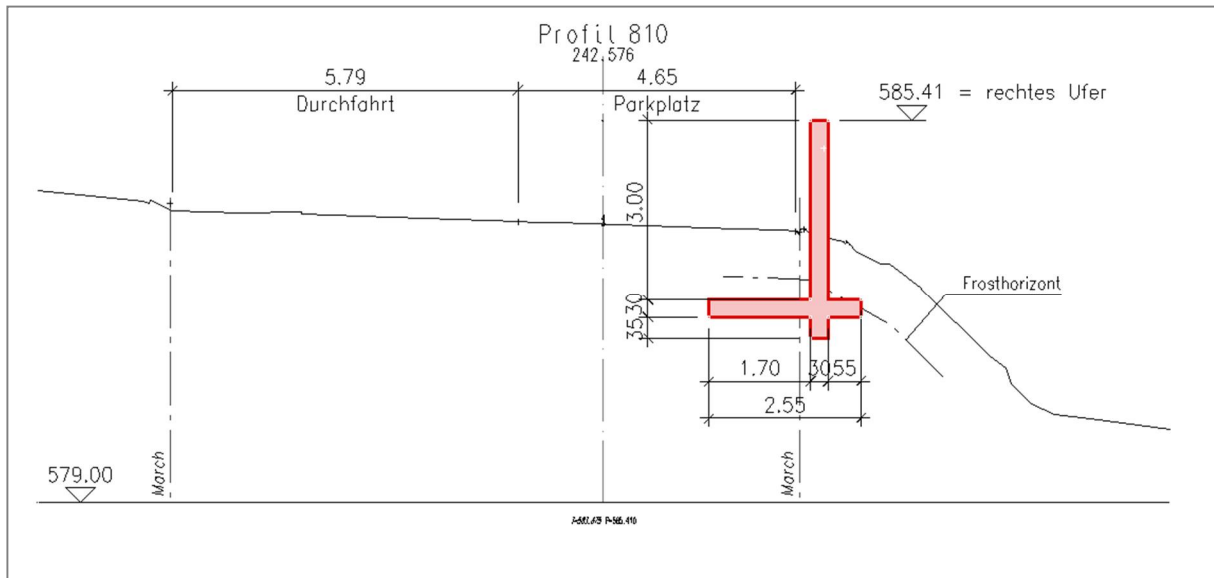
STATISCH VORDIMENSIONIERTER MAUERQUERSCHNITT AUF DEM ZULGUFER
